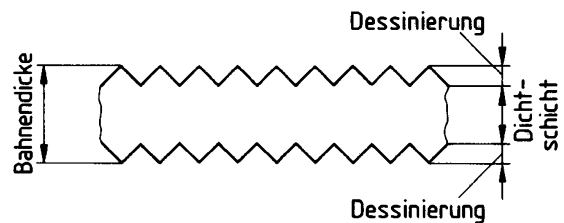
Querschnitt der Elastomer-Bahn mit beidseitiger Dessinierung
